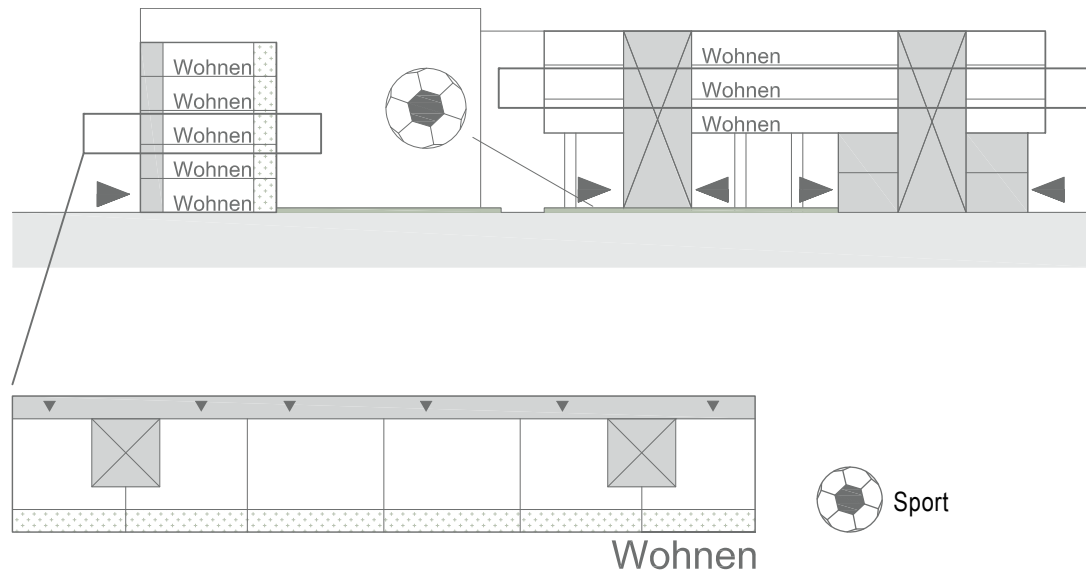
Funktionsschnitte und Grundrisse 1:1000
